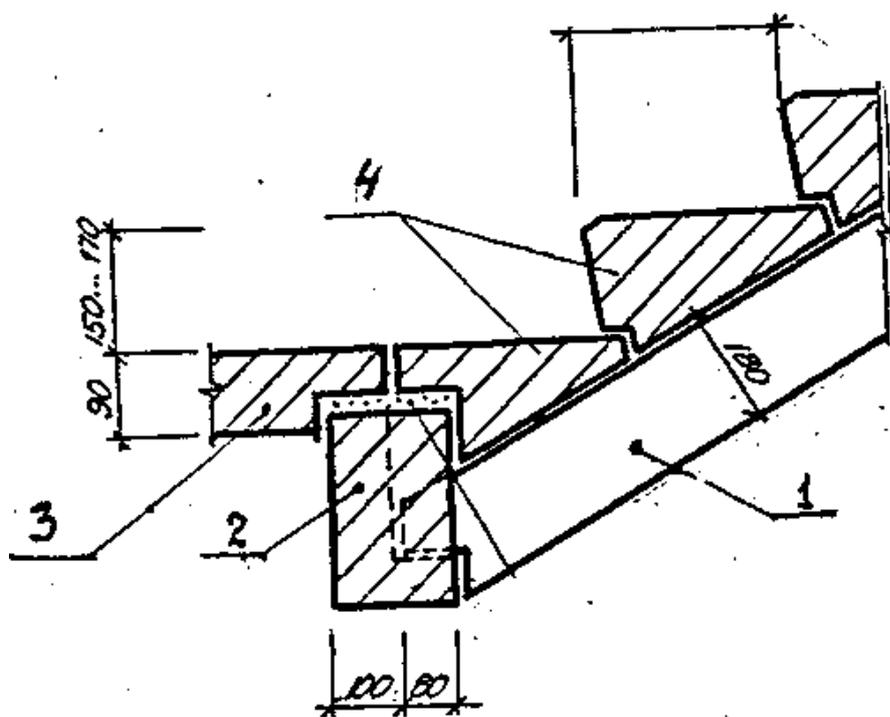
Конструкція сходів по залізобетонних косоурах: 1 – косоур 180x100; 2 – поперечна балка 300x180; 3 – сходовая площинка – 90; 4 – залізобетонні сходинок.
